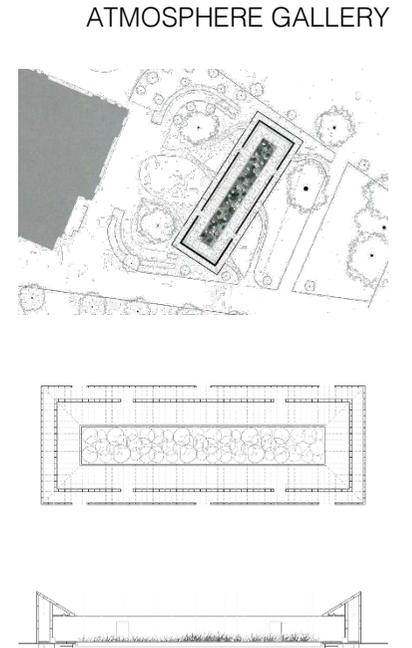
(1ª) Planta del pabellón en relación con la Serpentine Gallery. (2ª) Planta en detalle. (3ª) Sección longitudinal
